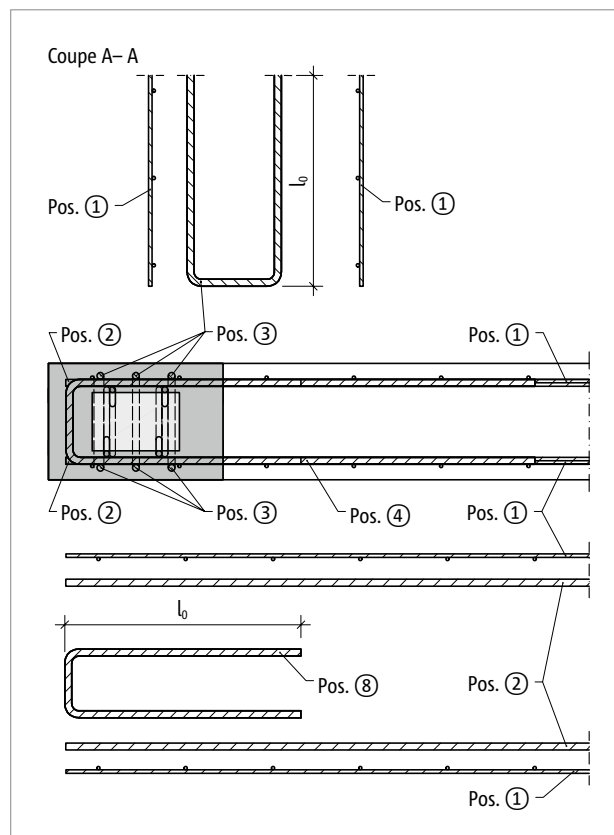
Schöck Sconnex® type W-N-VH : variante A – renforcement sur site avec Pos. 4 pour le raccordement en l'extrémité du mur
